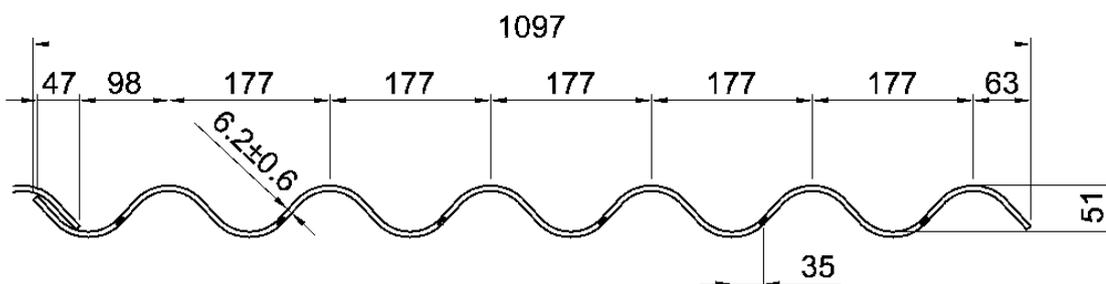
Wellplatte Profil P6 mit 6 Wellen
